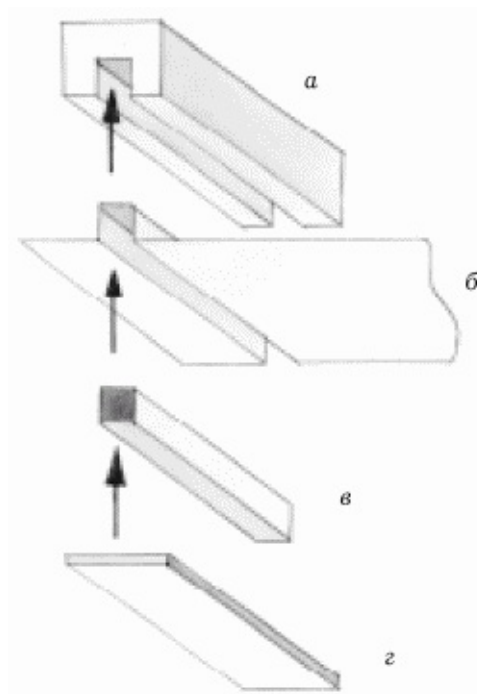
Устройство потолка кулачкового крепления: а – крепежный
